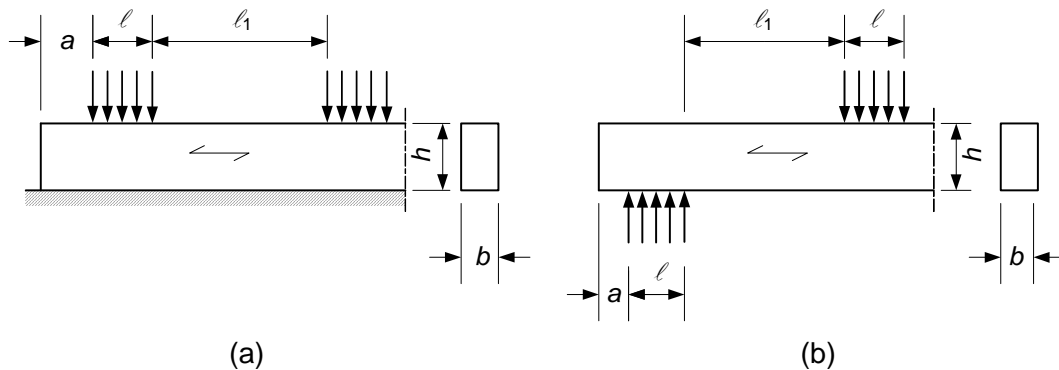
Bauteil mit einer (a) kontinuierlichen Lagerung und (b) Einzellagerung
